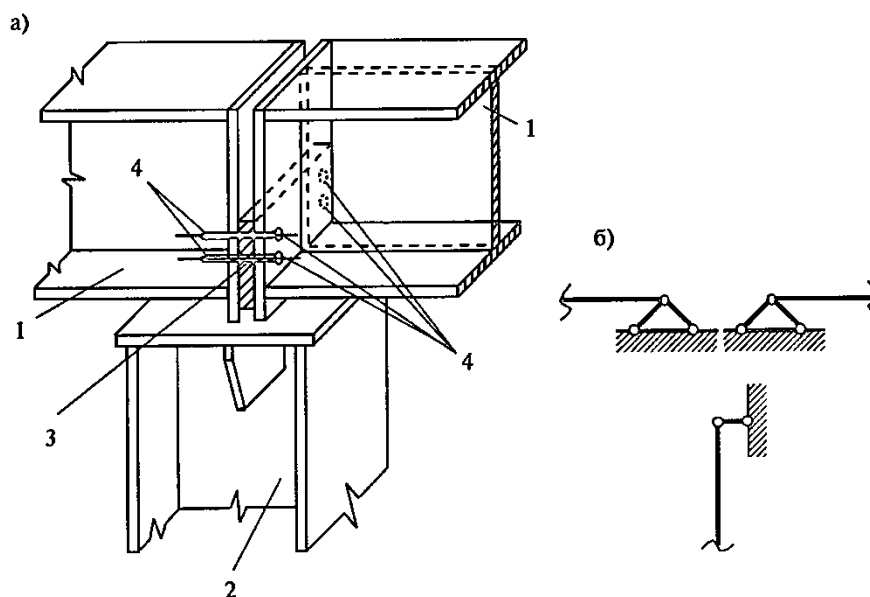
Шарнирное прикрепление балки к стальной колонне: а) схема опирания балок; б) расчетная схема опор для балок и колонны; 1 — балки; 2 — колонна; 3 — стальная прокладка; 4 — болты (гайка и головка болта не показаны)
